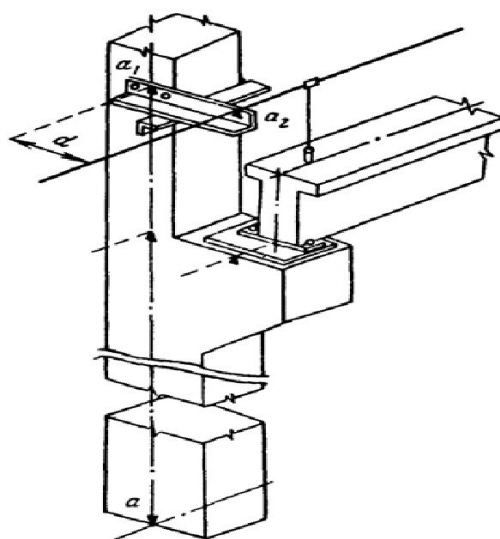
Схема установки в проектное положение подкрановых балок
